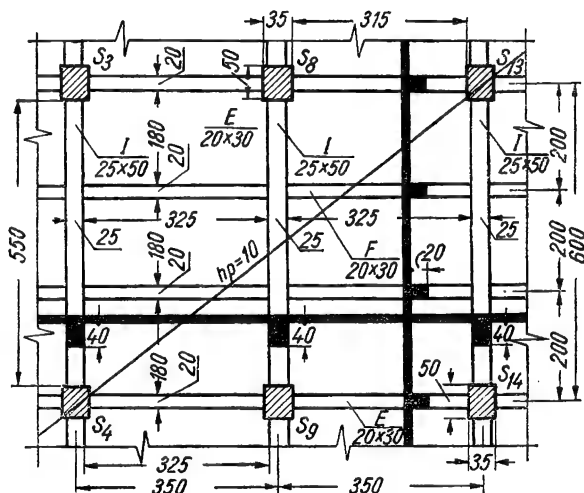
Planul cofrajului unui planșeu pe stilpi.
